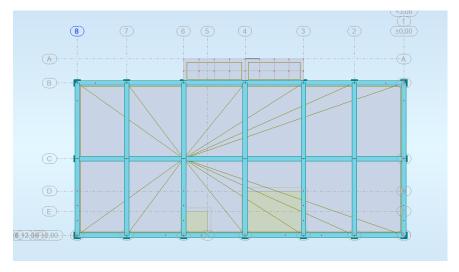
Vue en plan de la structure sur Autodesk ROBOT
